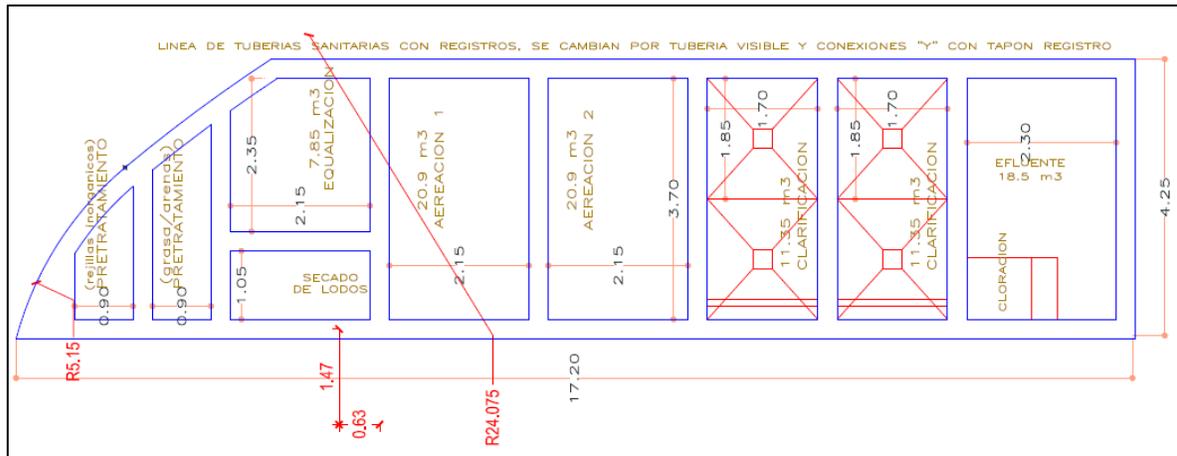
Planta arquitectónica de la Planta de tratamiento de aguas residuales.
